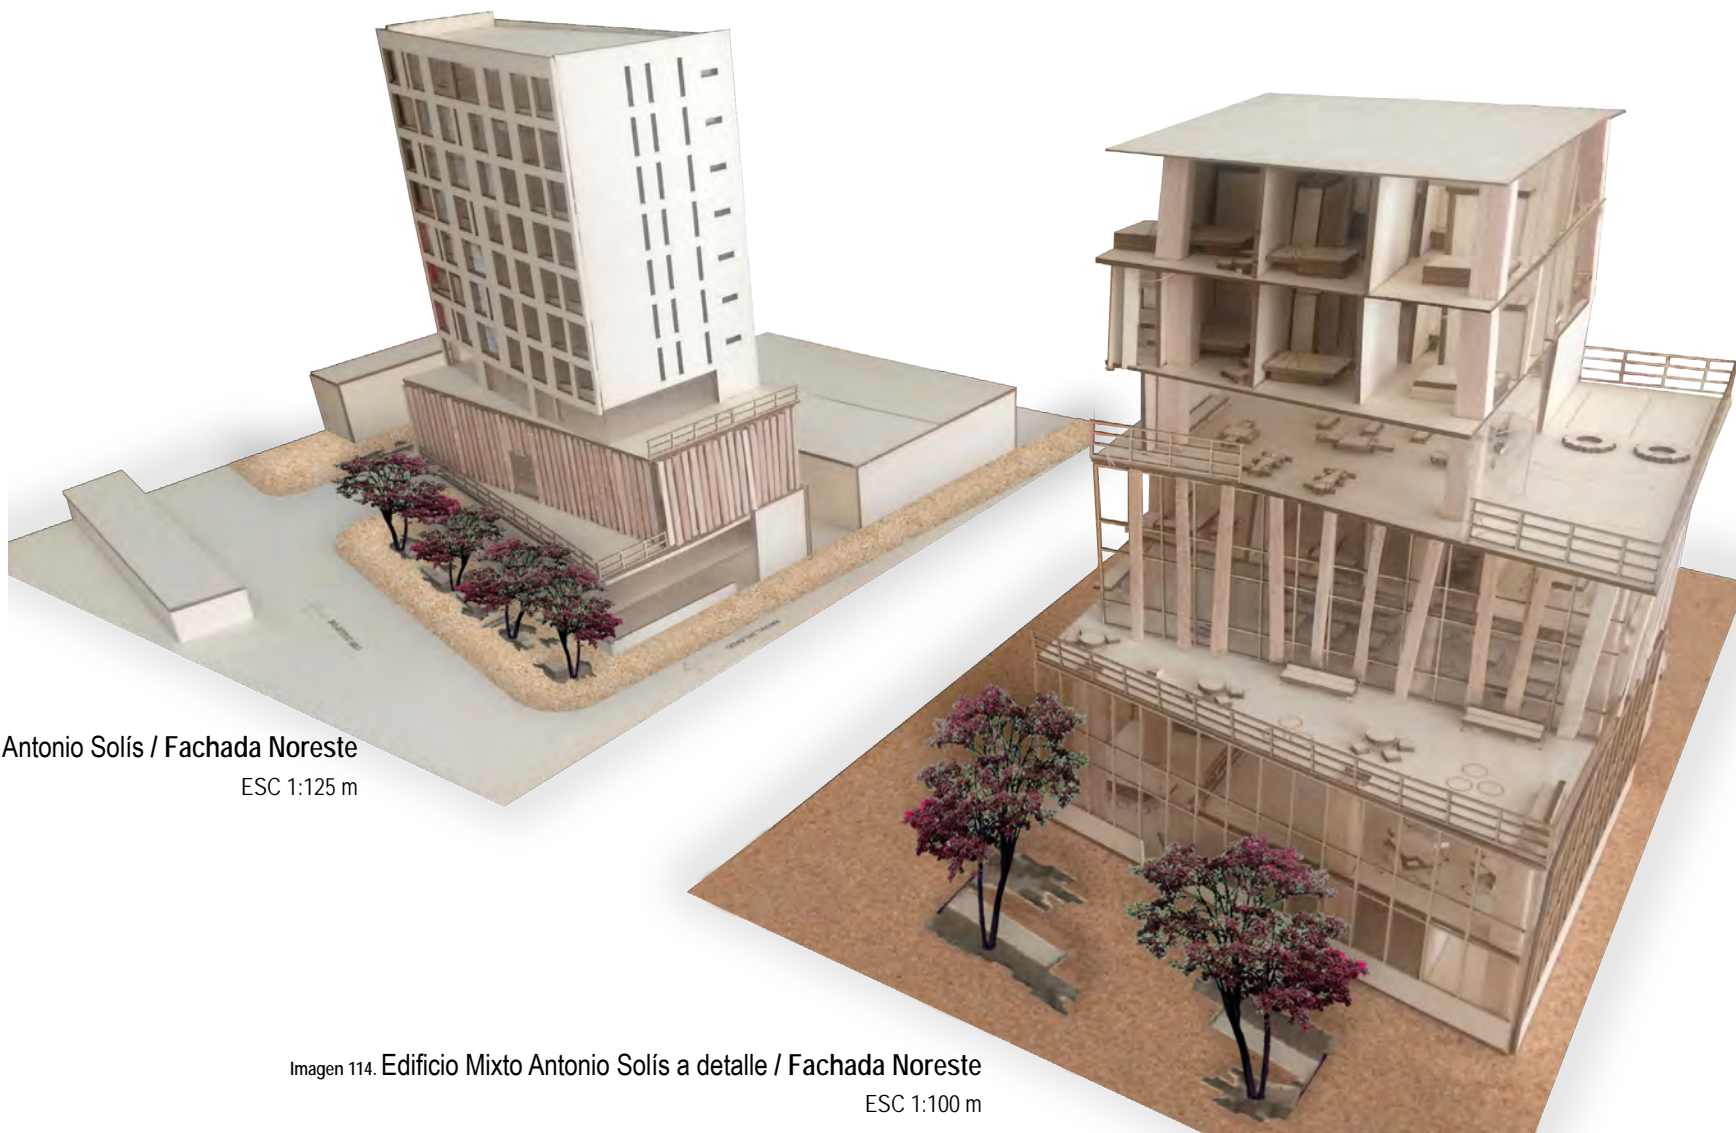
Edificio Mixto Antonio Solís / Fachada Noreste
